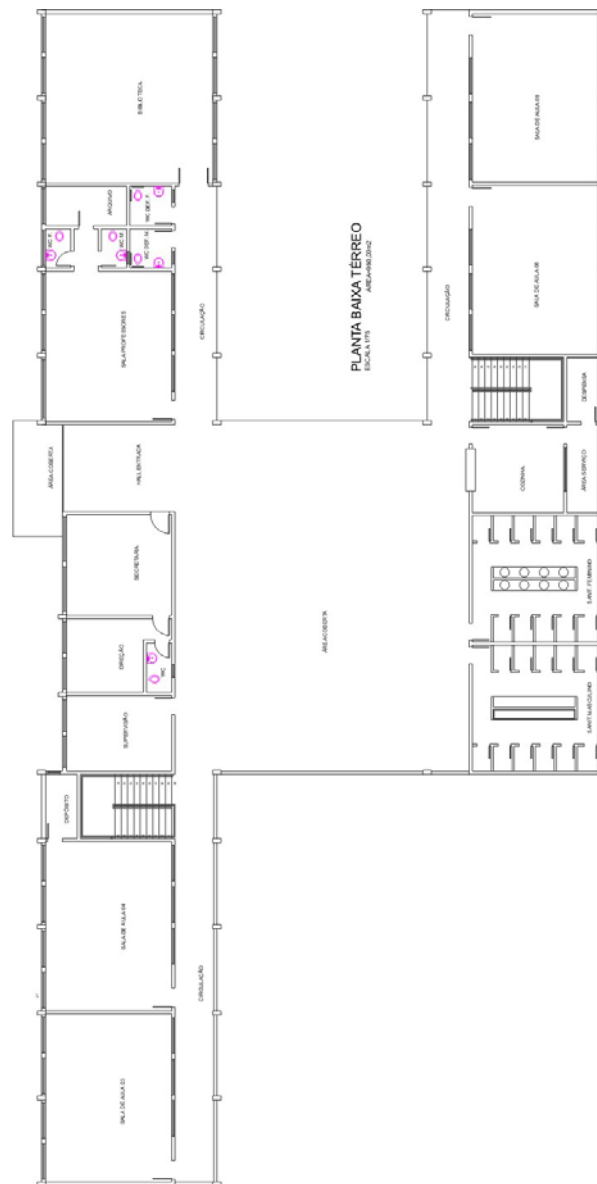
Planta baixa do pavimento térreo – Dilso Cecchin
